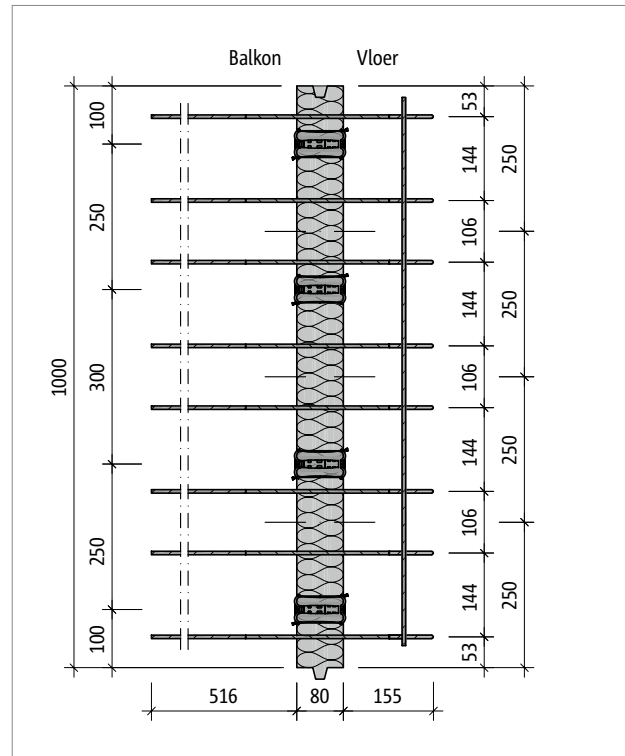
Schöck Isokorb® T type Q-E-V3: Doorsnede
